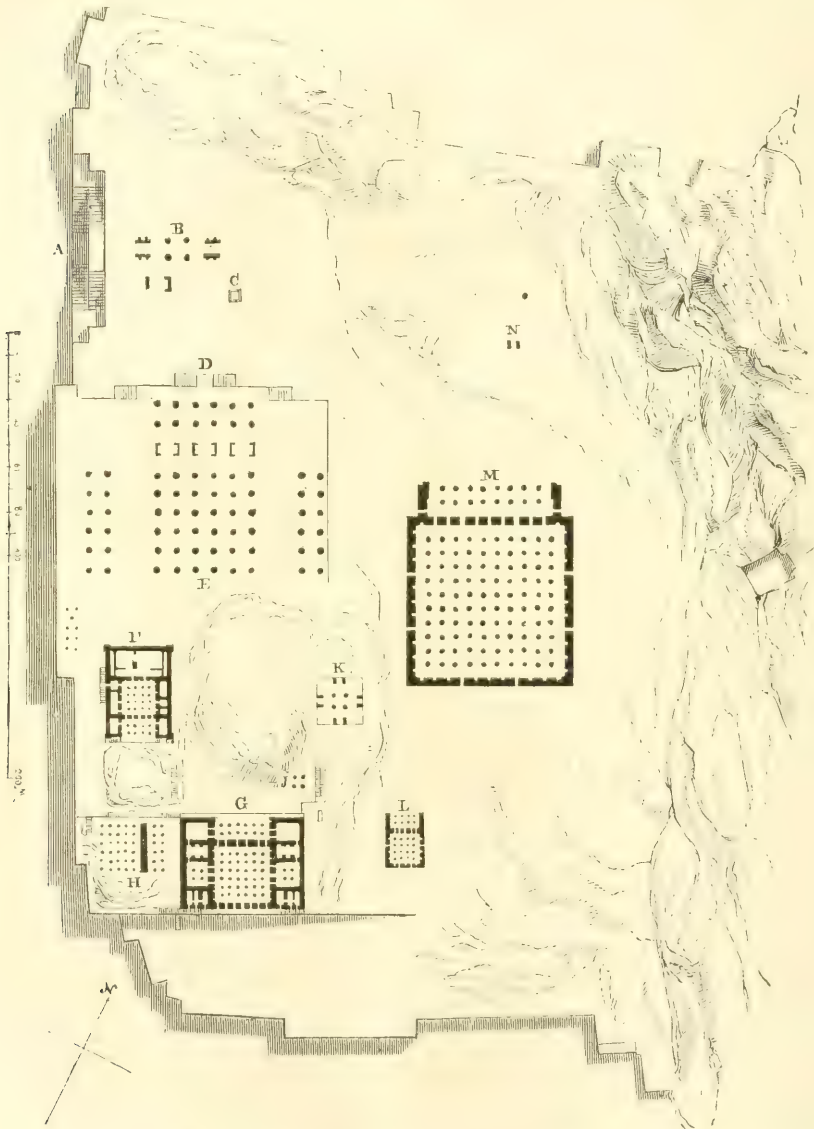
Grundriss von Persepolis. (Nach Texier und Caste-Flandin.)
